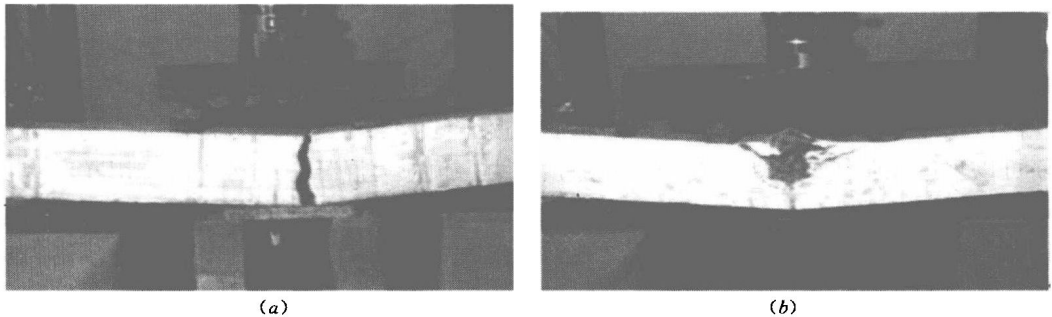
素混凝土简支梁和钢筋混凝土简支梁的受力和破坏形态
